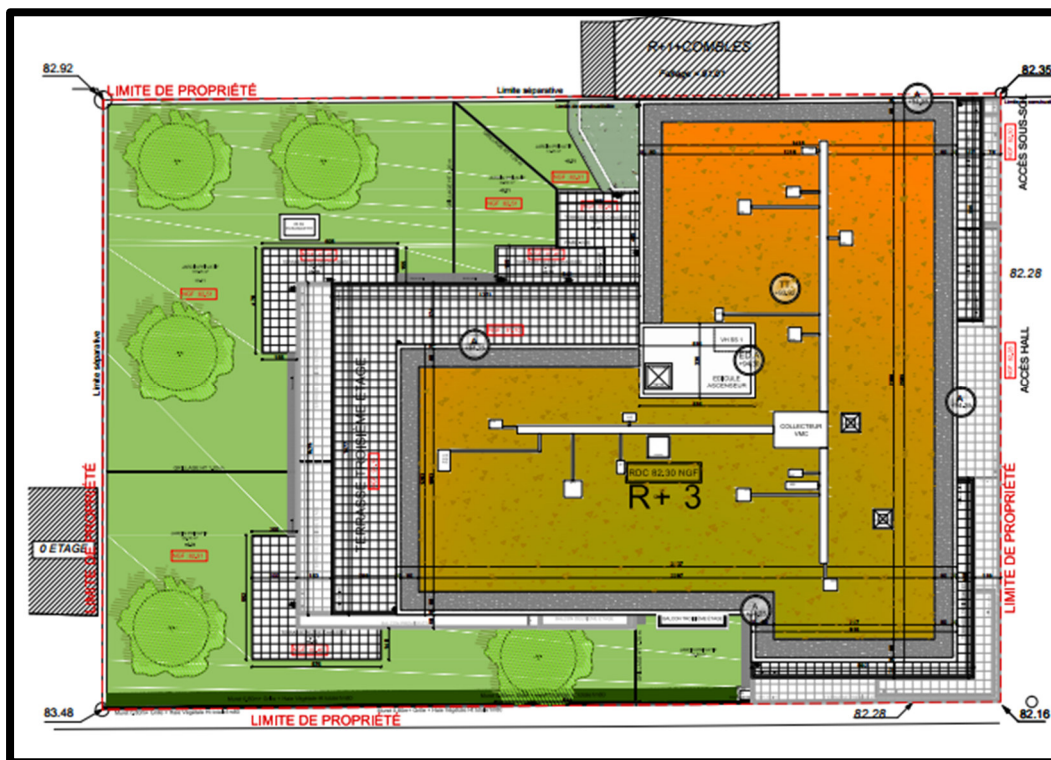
Planta Cobertura do edifício de estudo (fase projeto)
